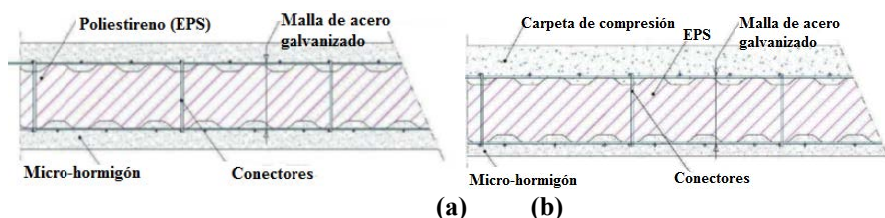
Detalles de paneles simples empleados como: (a) muros; (b) losas
